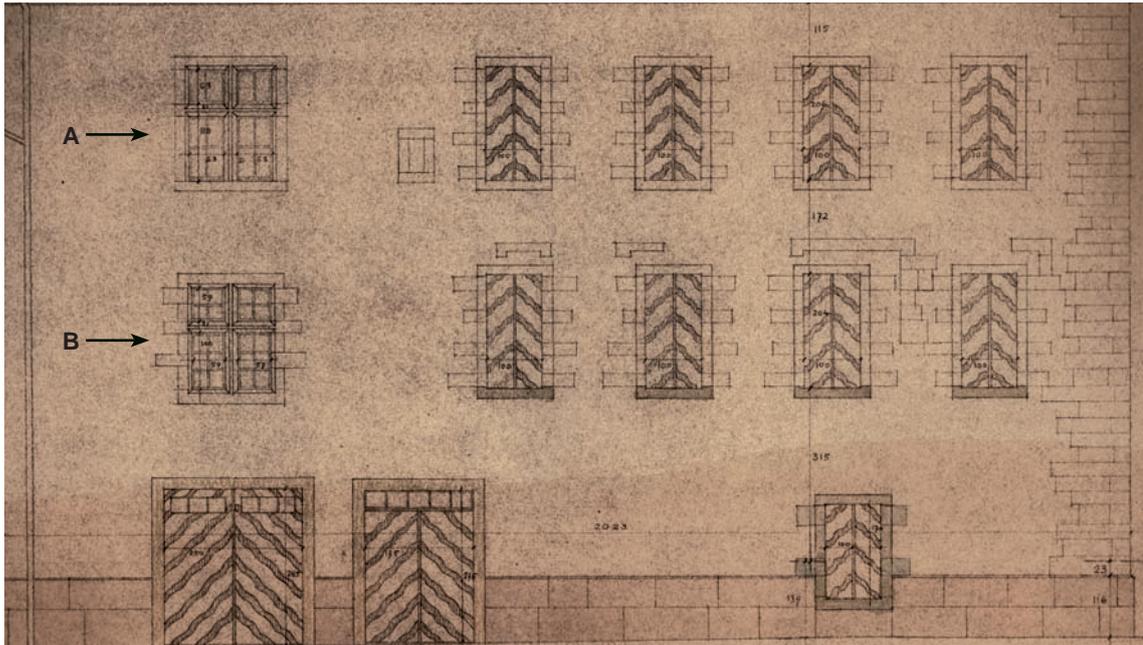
Façade est (ACPU, AA 2.1.0.3)
